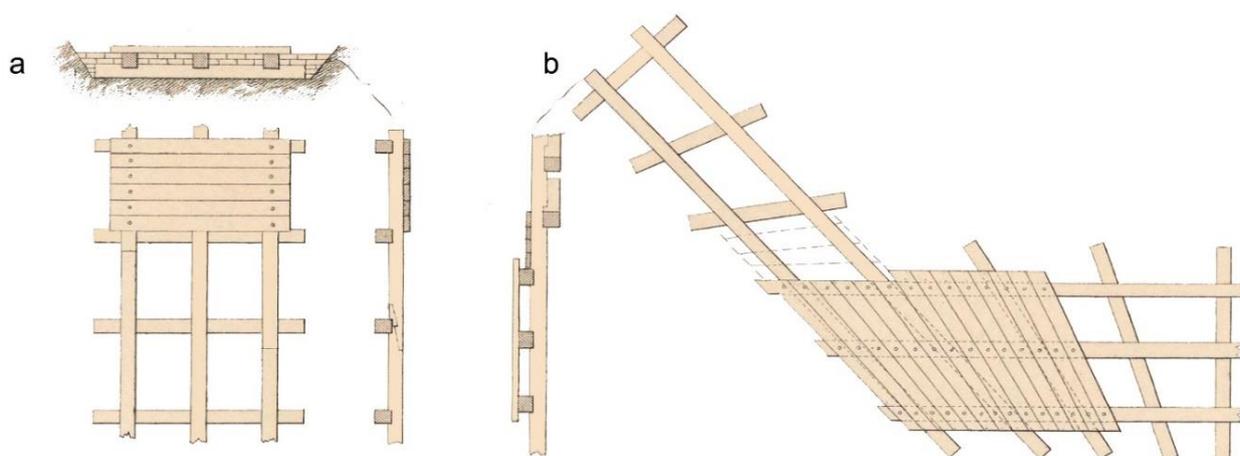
Усиление основания устройством ростверка: а – ростверк на прямолинейном участке подошвы с верхним дощатым настилом и забучиванием промежутков между брусьями; б – ростверк в примыкании не ортогонально расположенных стен [13]
